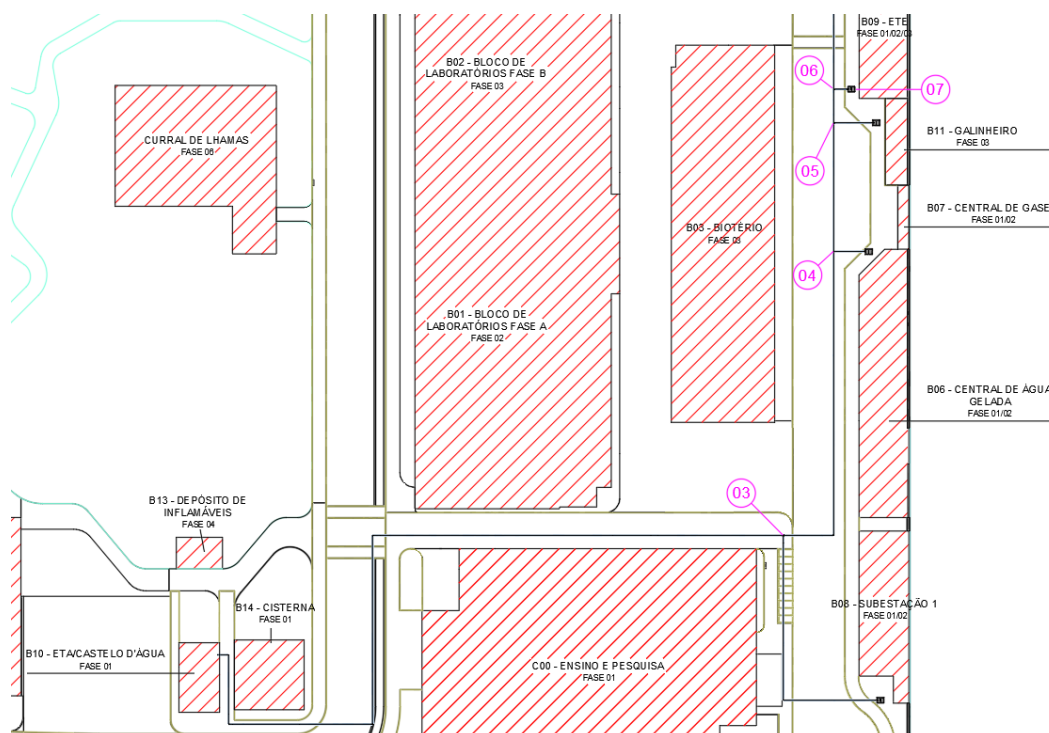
Planta trecho (Castelo d'água / Bloco B11)
